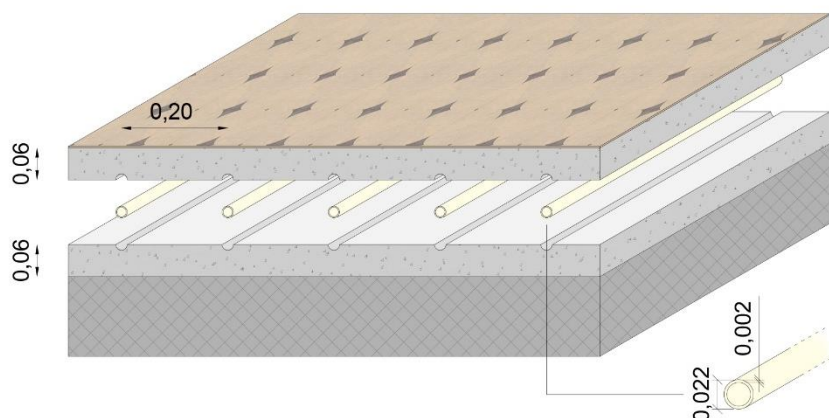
Schema dell'impianto radiante a pavimento considerato.
